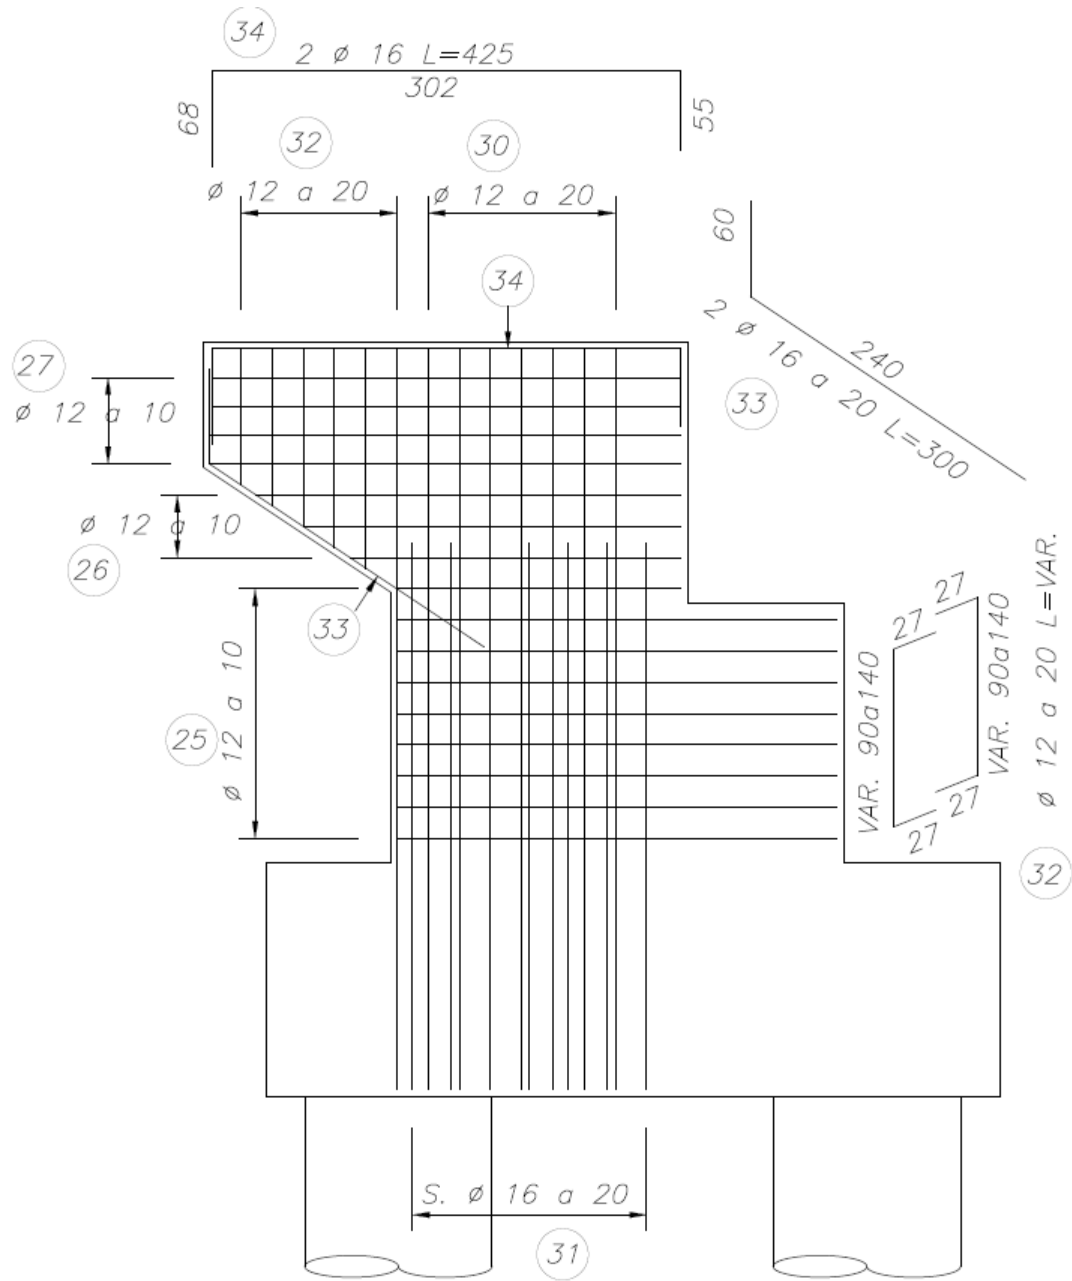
Vista en Elevación Muro Ala Puente Águila Norte.
